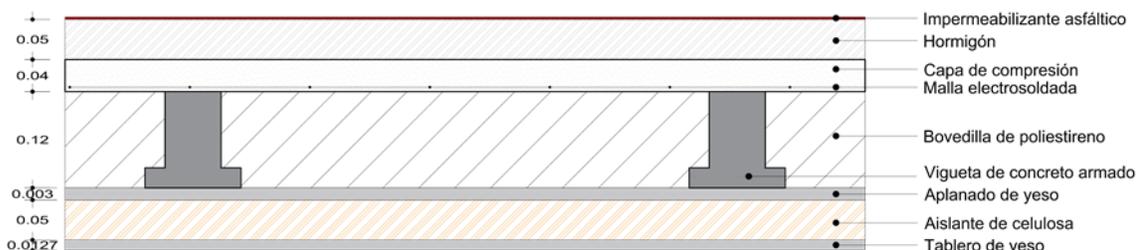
Detalle de losa con aislante de celulosa (Corte)
